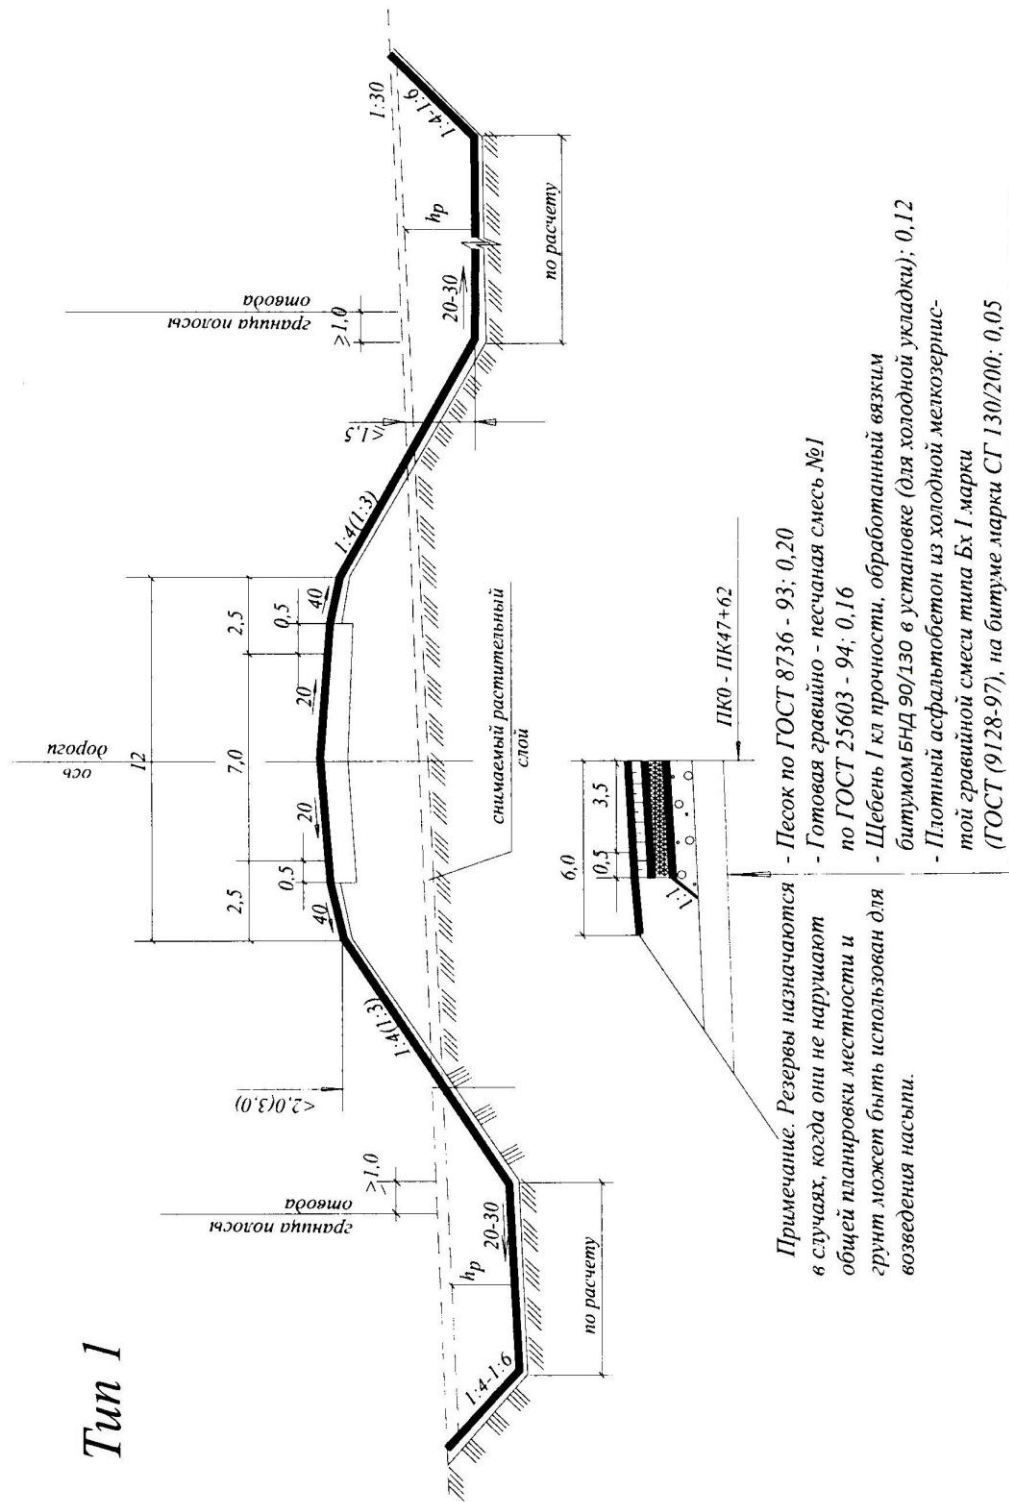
Типовая конструкция поперечного профиля земляного полотна с боковыми резервами
